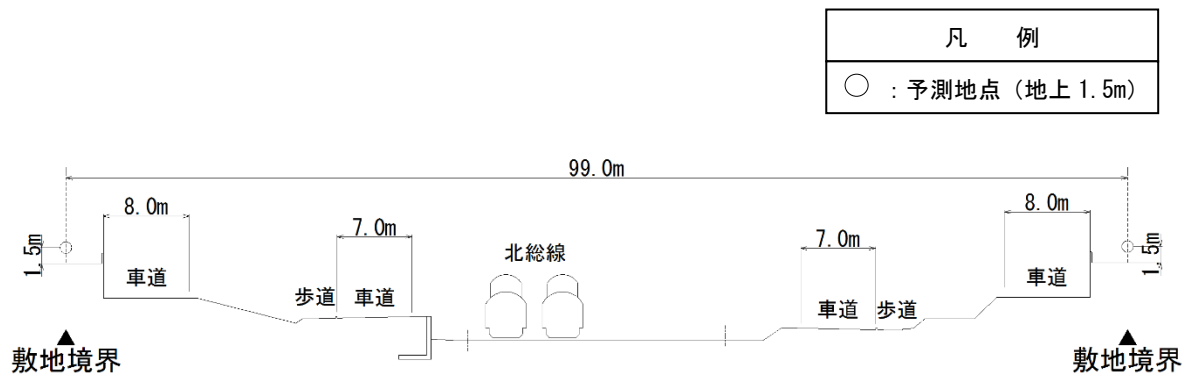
(10) 予測断面図 (J. 一般国道464号 (6))
